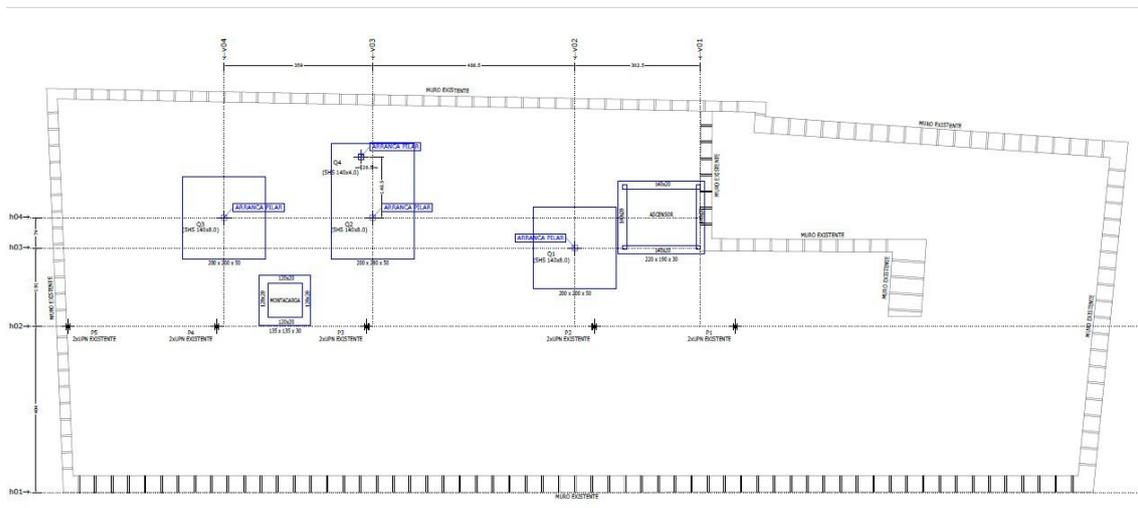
Planta del inmueble con los elementos estructurales bajo rasante
